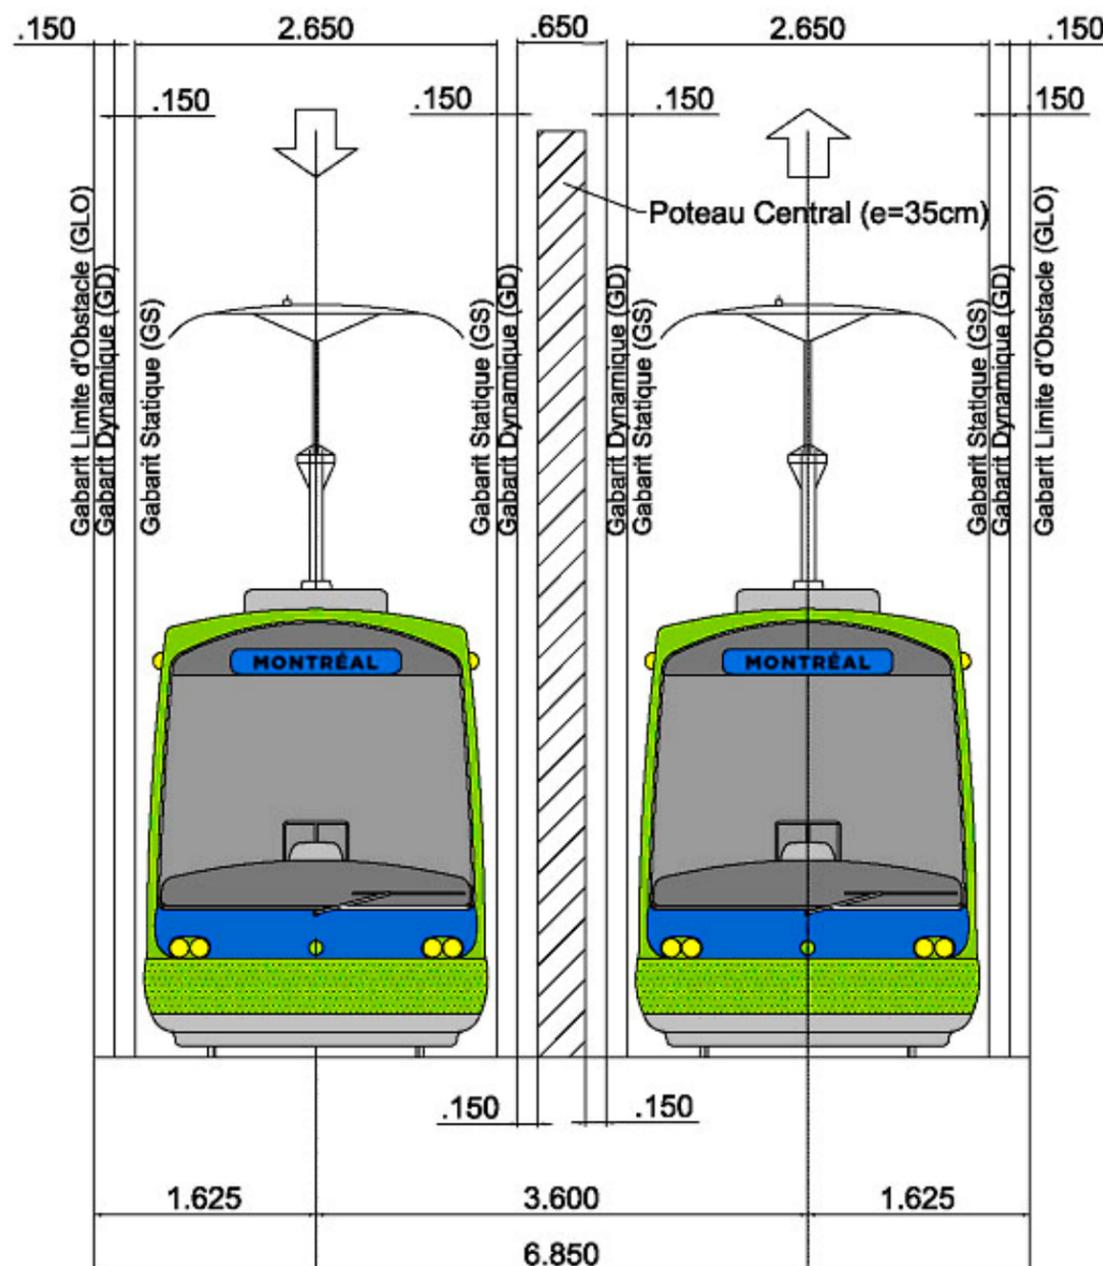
GLO en voie double – Alignement droit avec poteaux centraux
